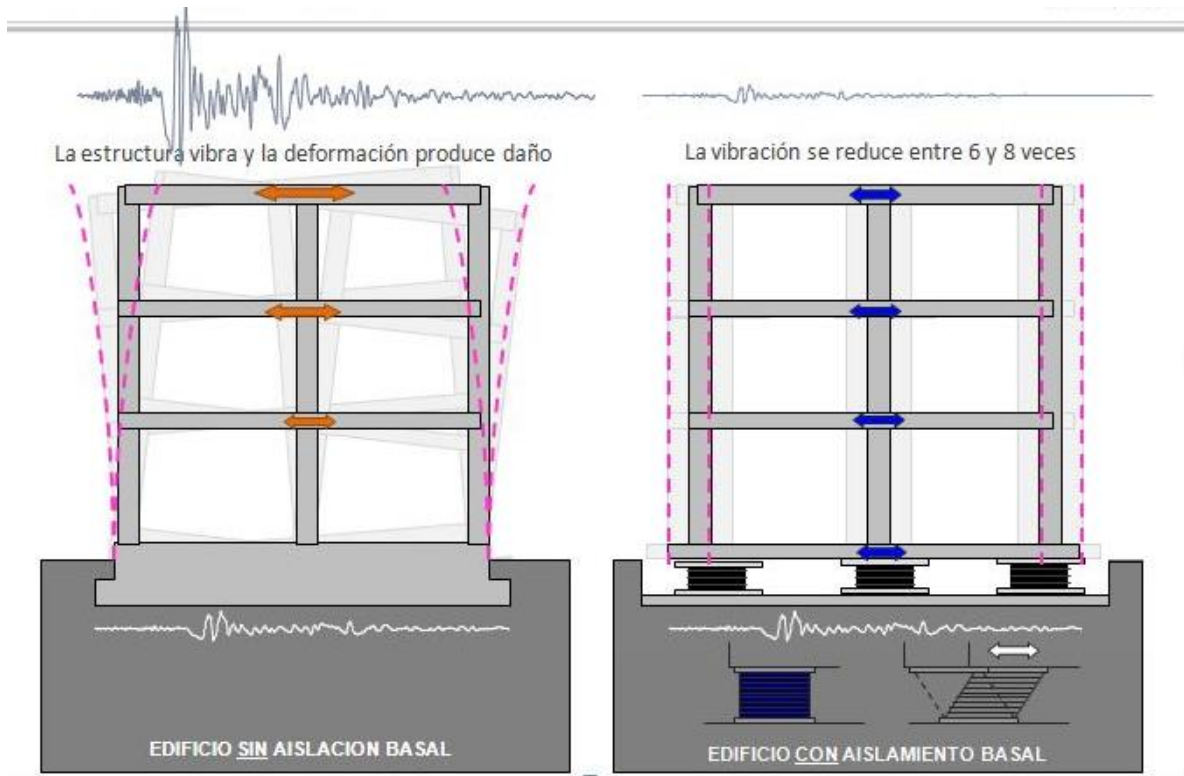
Comparación de comportamiento estructural con aislamiento basal (Silverio, 2011)
